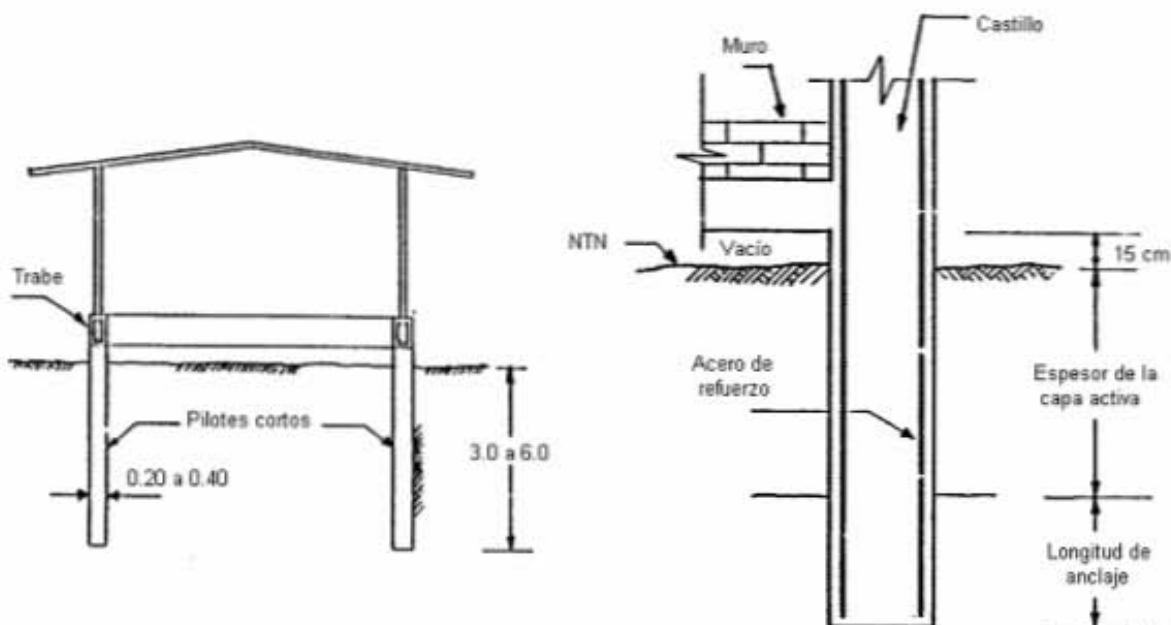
Cimentación a base de pilotes cortos (palafito).
